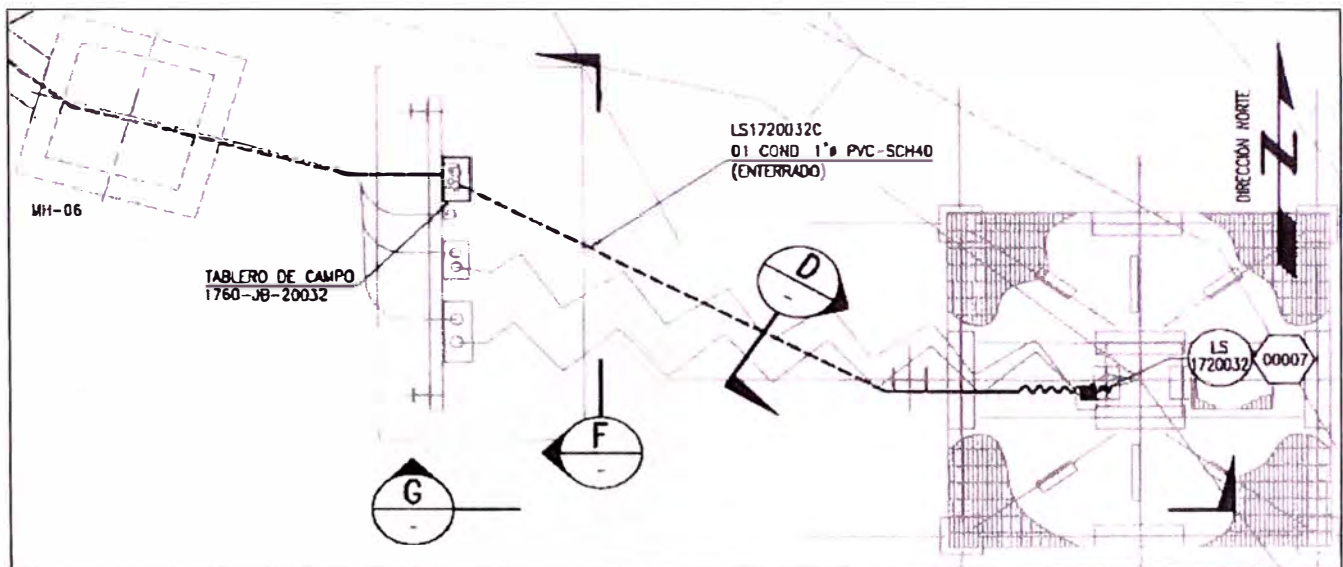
Disposición de instrumentos de la poza sub-drenaje
